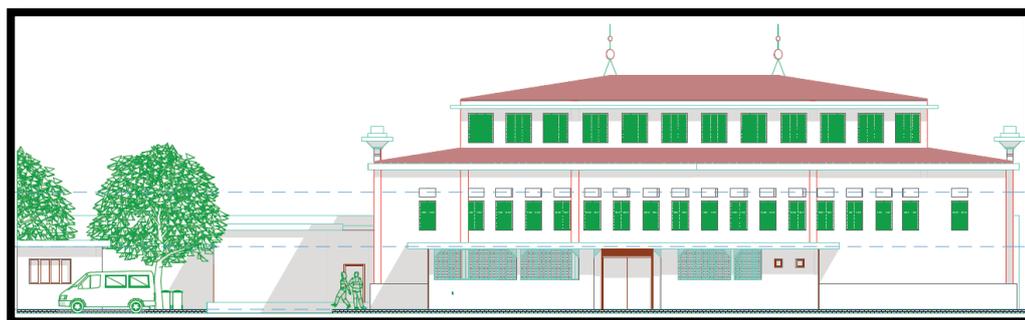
représente la façade latérale du marché couvert. (Source : auteur).
